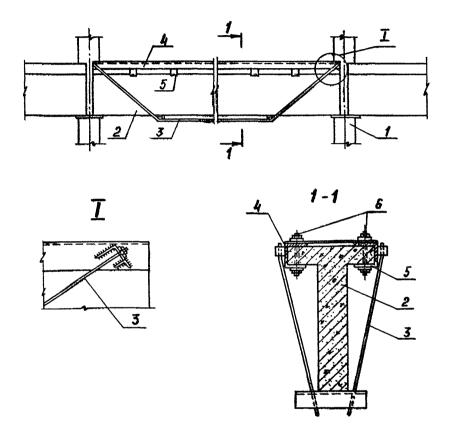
Усиление железобетонных подкрановых балок обоймой из уголков со шпренгелем
